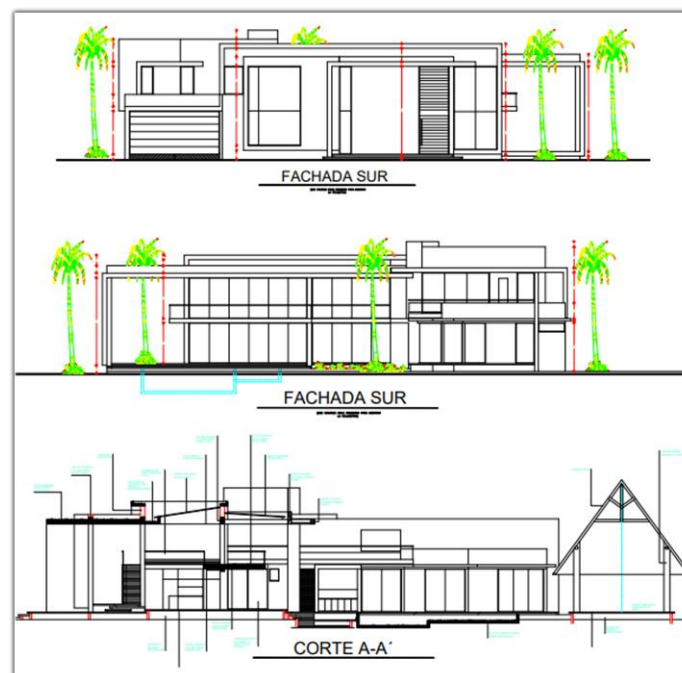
Fachadas y corte. Fuente: Planos AutoCAD.
